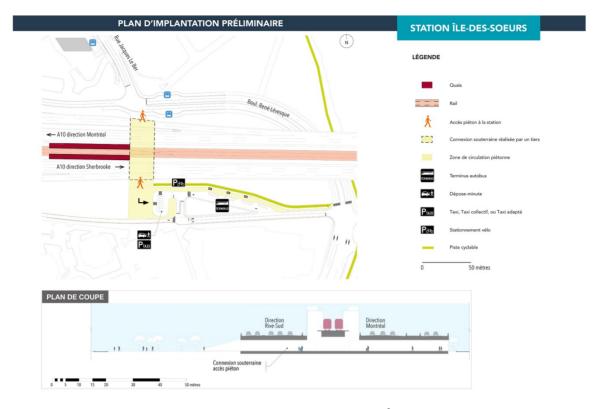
Plan d'implantation de la station Île-des-Sœurs
